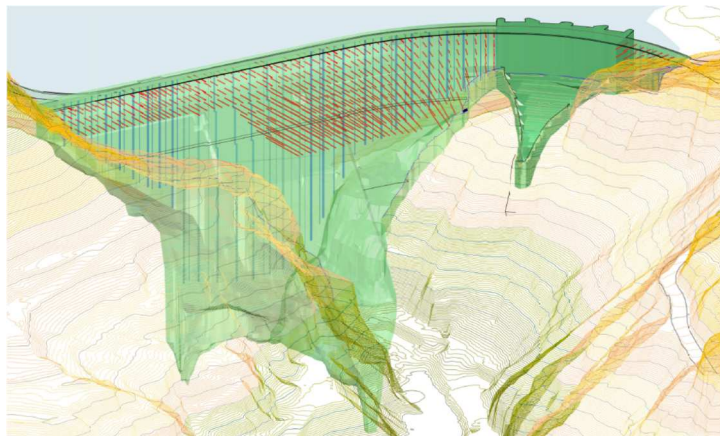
tirants (en rouge) et plan de drainage d'auscultation (en bleu)
